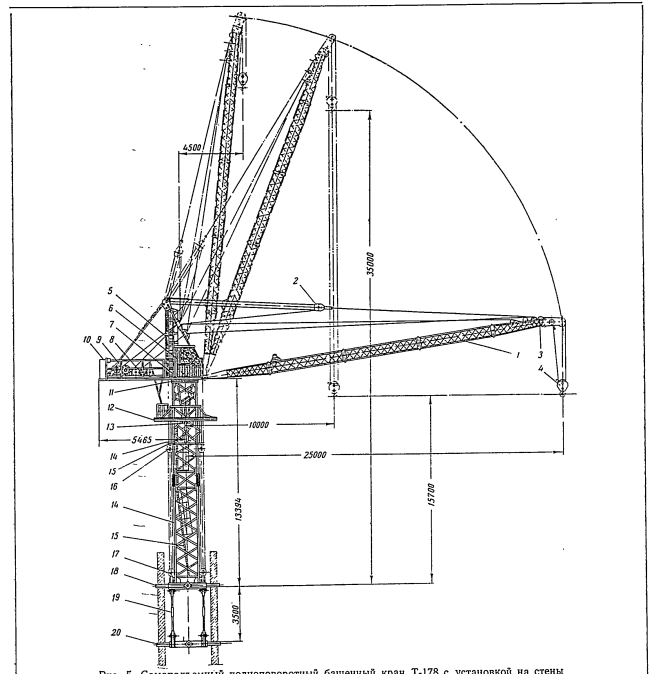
Самоподъемный полноповоротный башенный кран Т-178 с установкой на стены здания: 1 — стрела; 2 — полиспаст подъема стрелы; 3 — ограничитель подъема; 4 — крюк с обоймой; 5 — стойка с блоками; 6 — кабина; 7 — поворотный механизм; 8 — лебедка подъема груза; 9 — стрелоподъемная лебедка; 10 — противовесная консоль с механизмами; 11 — верхние опорные катки; 12 — опорная клетка; 13 — нижняя опора хвостовика; 14 — башня; 15 — лестница; 16 — верхние блоки полиспаста подъема крана; 17 — нижние блоки полиспаста подъема крана; 18 — выдвижные опоры; 19 — стрелки; 20 — нижние выдвижные опоры.
